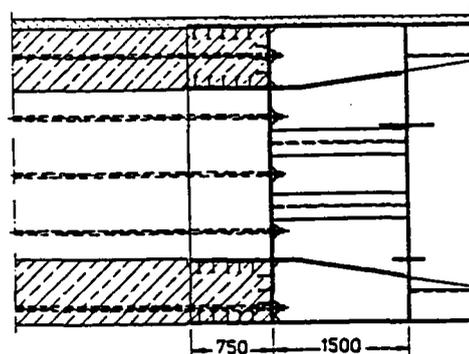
鋼桁と鉄筋コンクリート桁の連結部の構造
